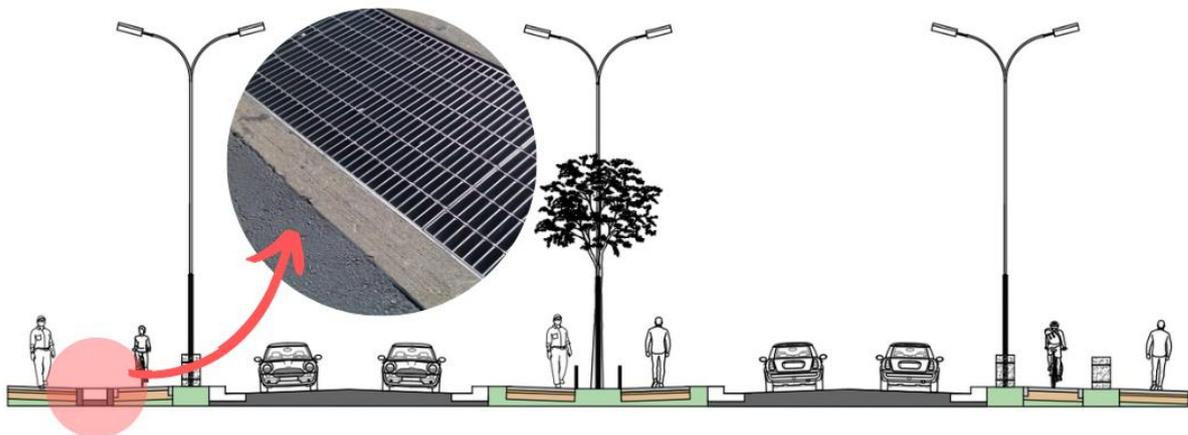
Anteproyecto vial: drenaje – cuneta lateral.
